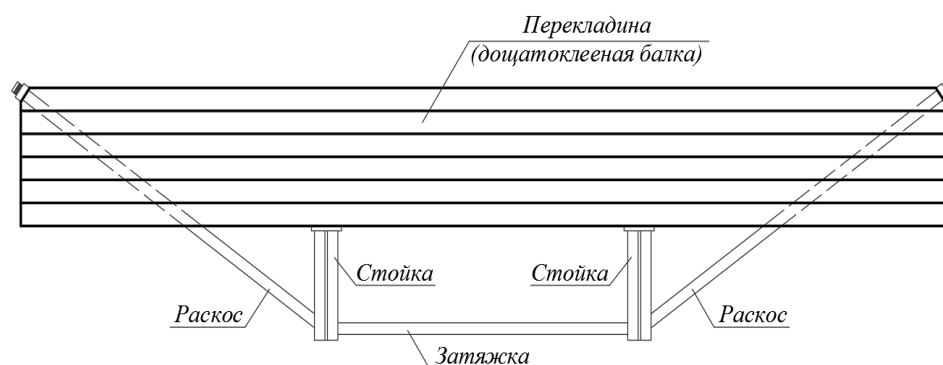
Конструктивная схема металлодеревянной подкрановой балки
